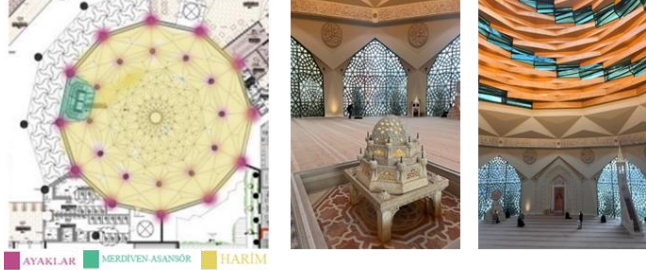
Marmara İlahiyat Camii Vaziyet Planı ve Kat Planı
